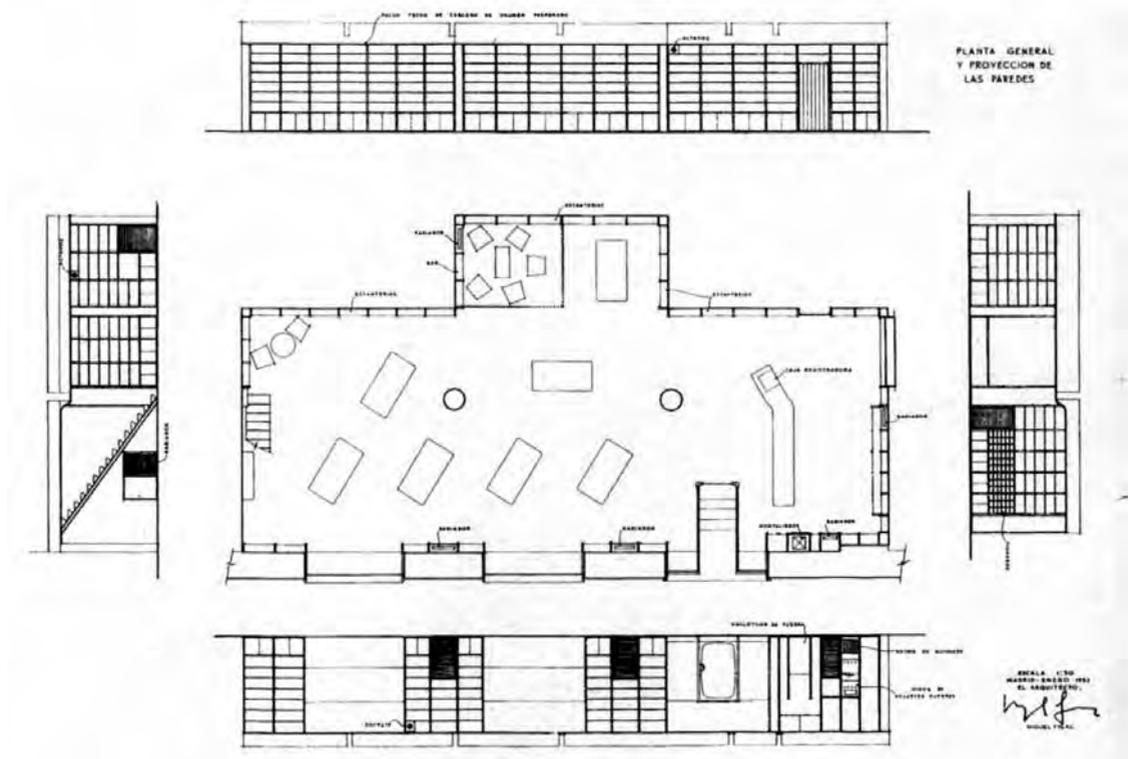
Planta y alzados de la Librería del CSIC, Miguel Fisac, 1950.
